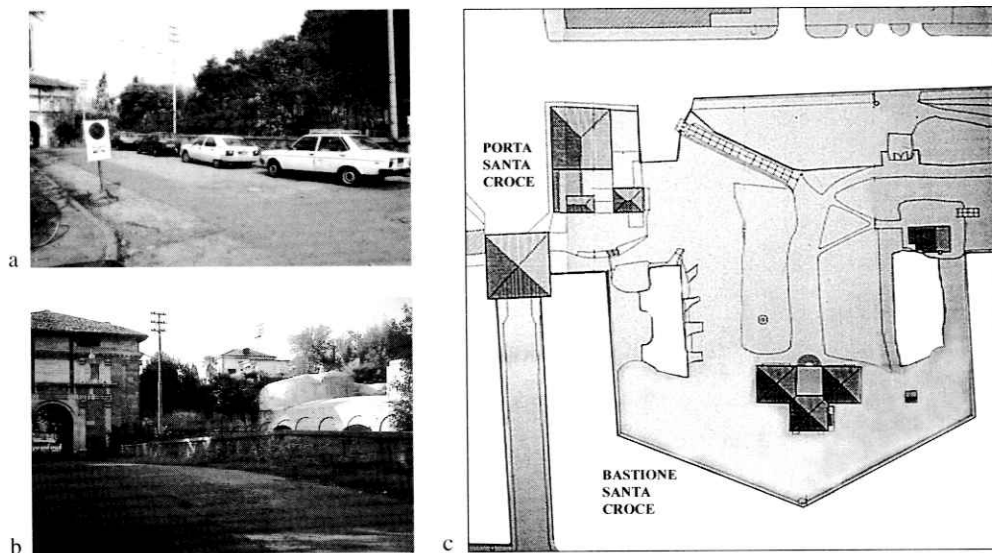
Il bastione Santa Croce: a) prima e b) dopo l'intervento di rimozione della vegetazione; c) planimetria.
